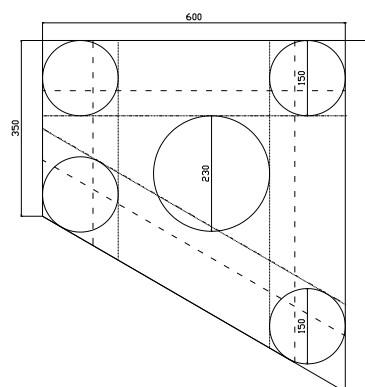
Vue en coupe de l'encombrement du placard technique (dimensions en mm).
